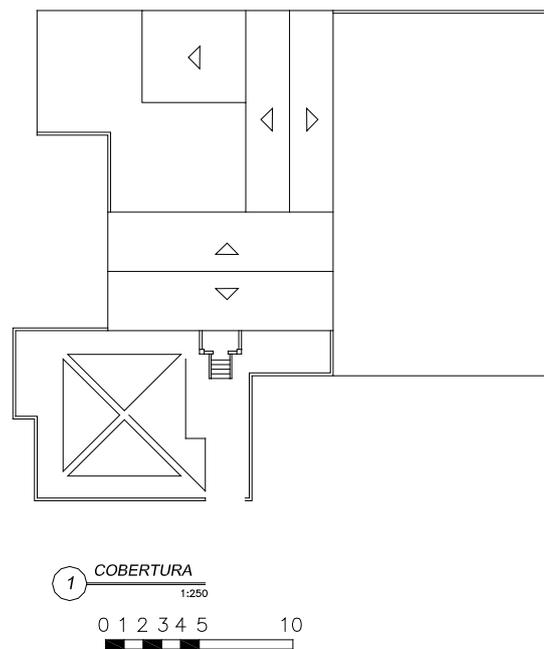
Planta situação / diagrama de telhado - Casa Armando Porcari
